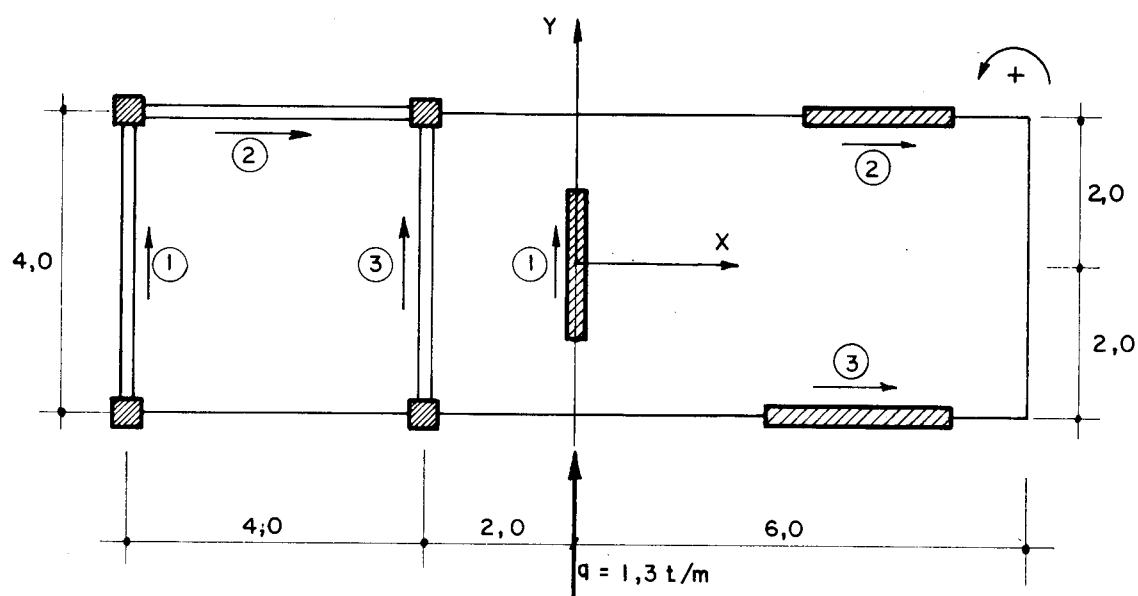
Estrutura em planta do terceiro exemplo de aplicação
